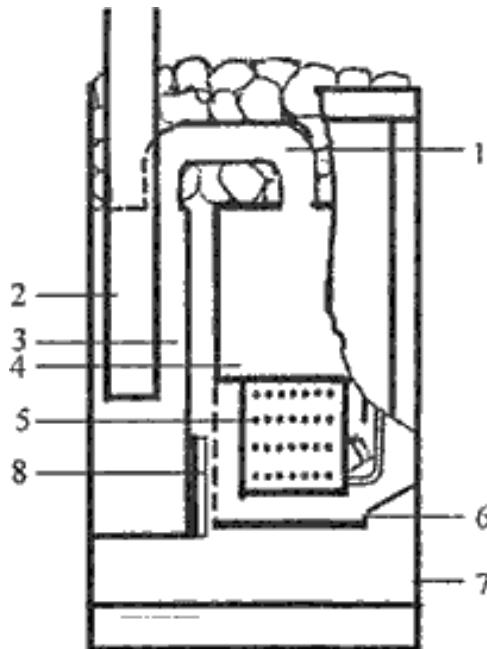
Печь-каменка фирмы «Васта»: 1 — перепускной газоход; 2 — дымоход; 3 — задняя секция; 4 — камера сгорания; 5 — горелка; 6 — внутренний корпус; 7 — внешний корпус; 8 — прочистка.
